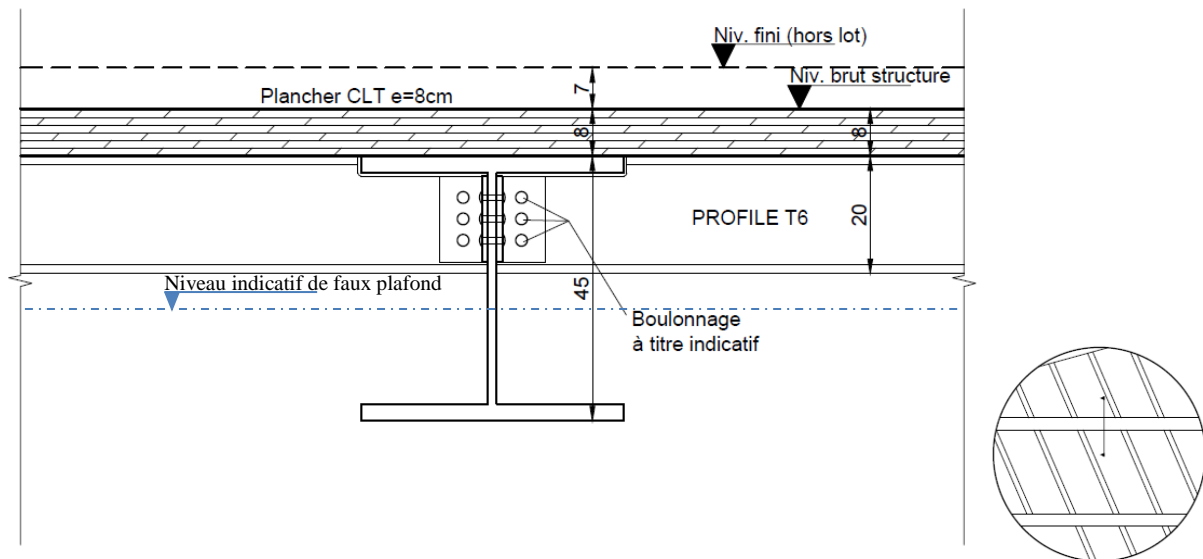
Coupe sur assemblage poutre primaire / solive // © bordas+peiro
